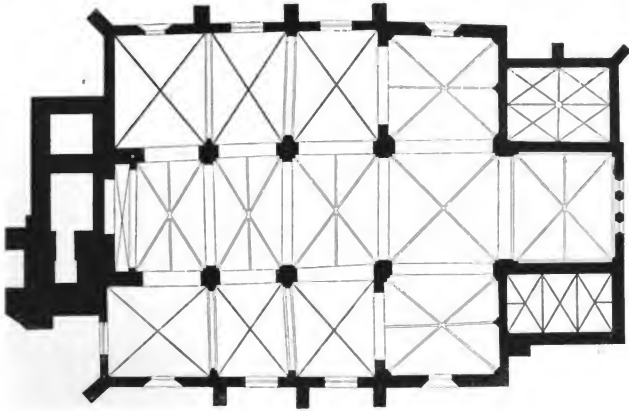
Stephanikirche. Grundriß vor dem Umbau.
